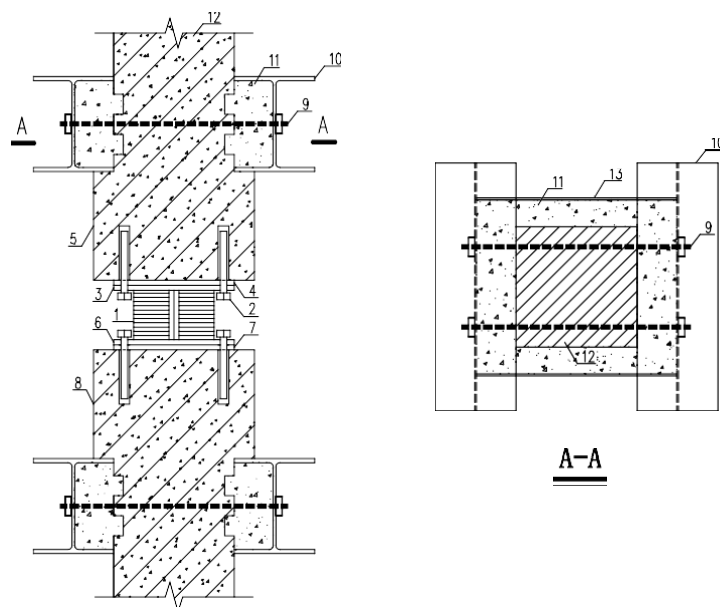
型钢混凝土框架柱托换及隔震支座安装示意图
